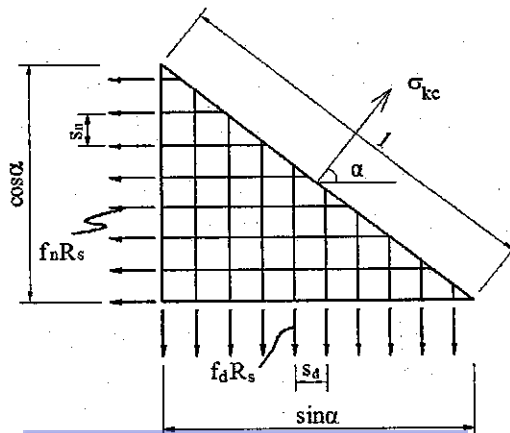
Sơ đồ tính toán vách bê tông cốt thép
